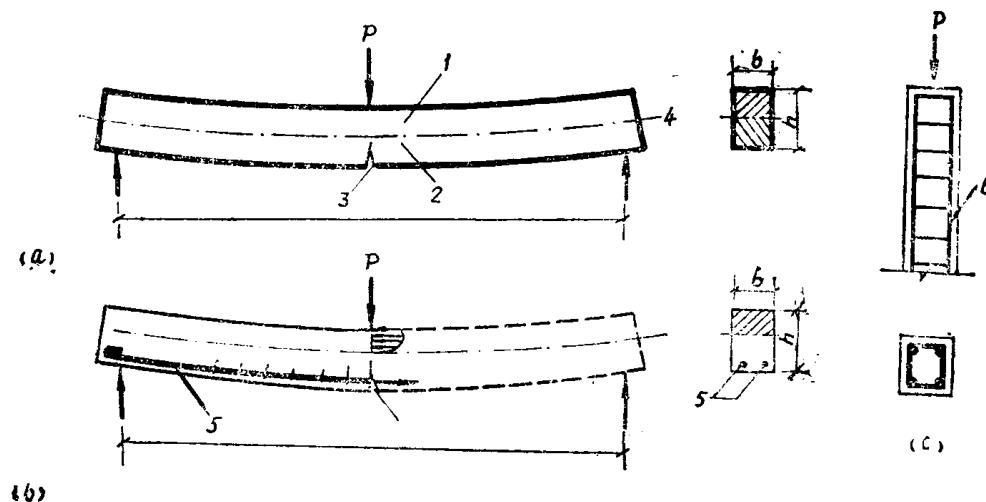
1 混凝土及钢筋混凝土结构承受荷载后情况
